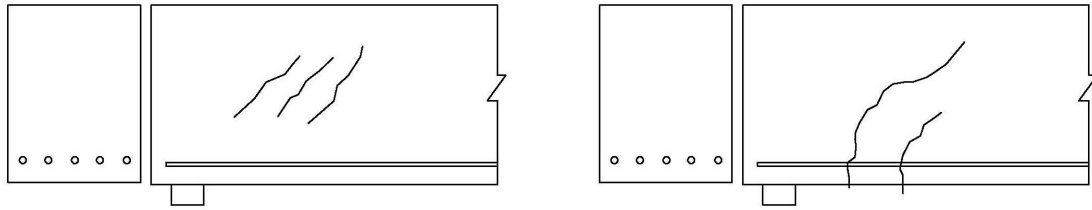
Grietas de cortante y grietas de flexión-cortante
